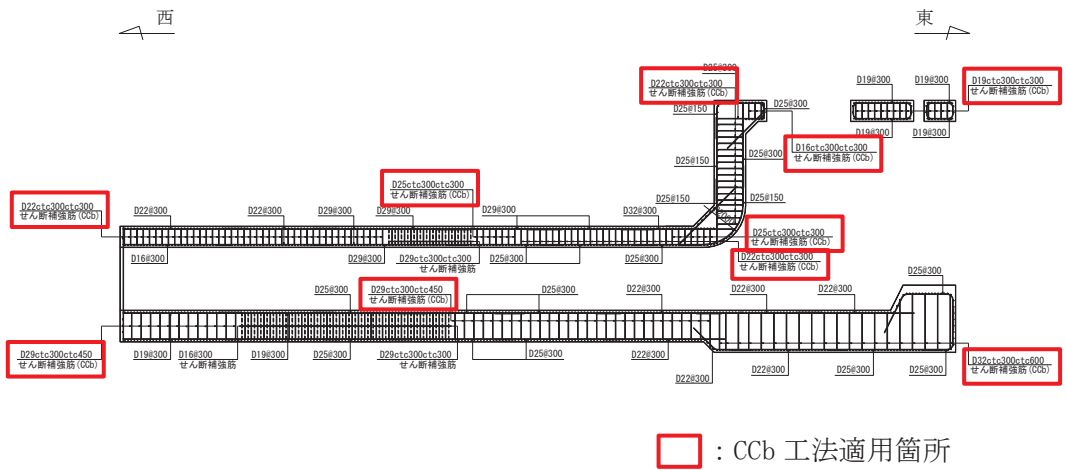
取水口概略配筋図 (E-E 断面, 東西)
